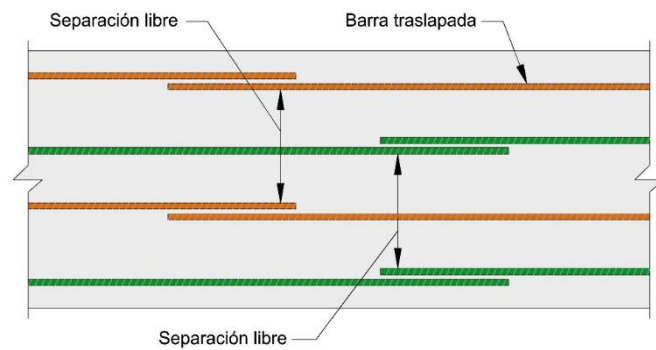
Separación libre entre traslapes para calcular L_d en traslapes alternados
